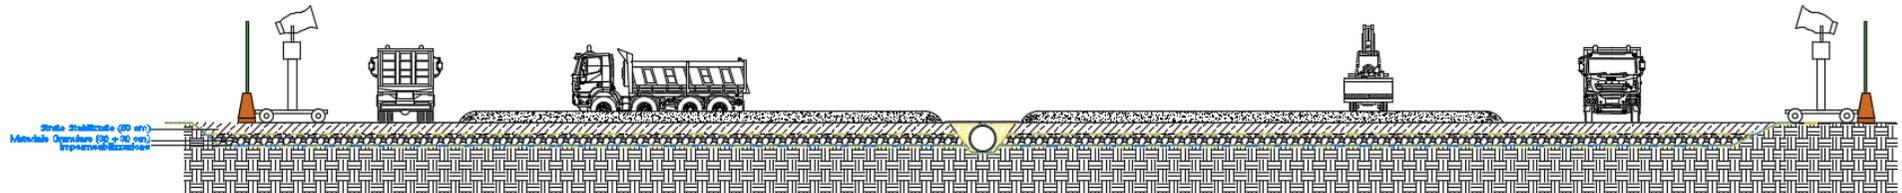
Planimetrie campi di stabilizzazione 1 e 2
